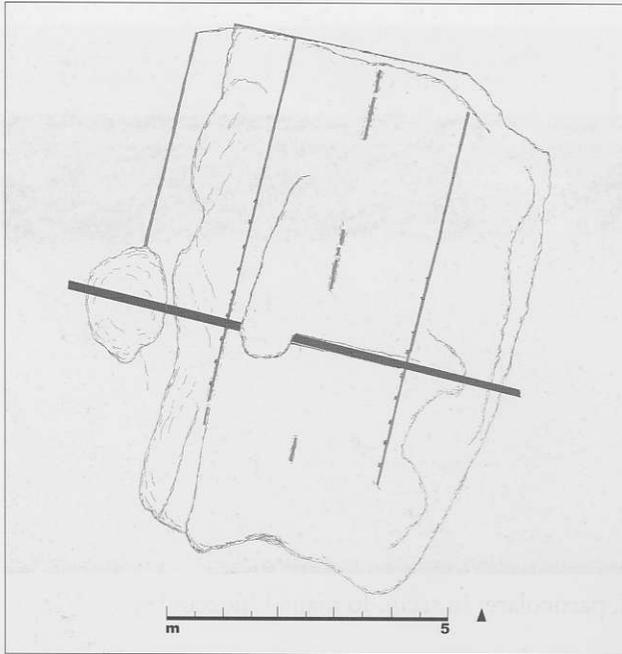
Astura, molo destro, blocco III: planimetria.
